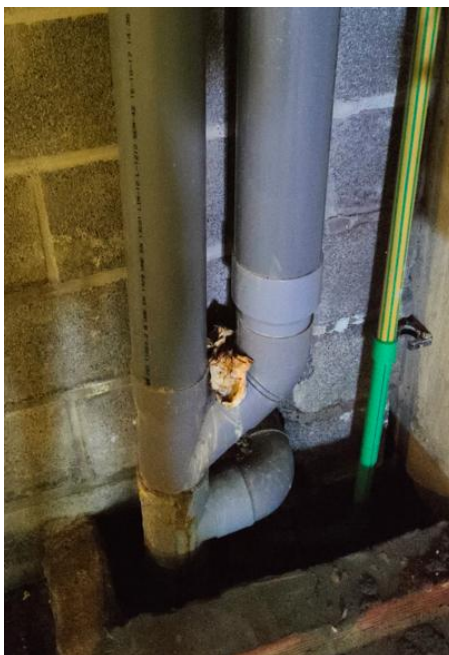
Imagen de la conexión del colector de vertidos con la bajante del baño del edificio de turbinado
